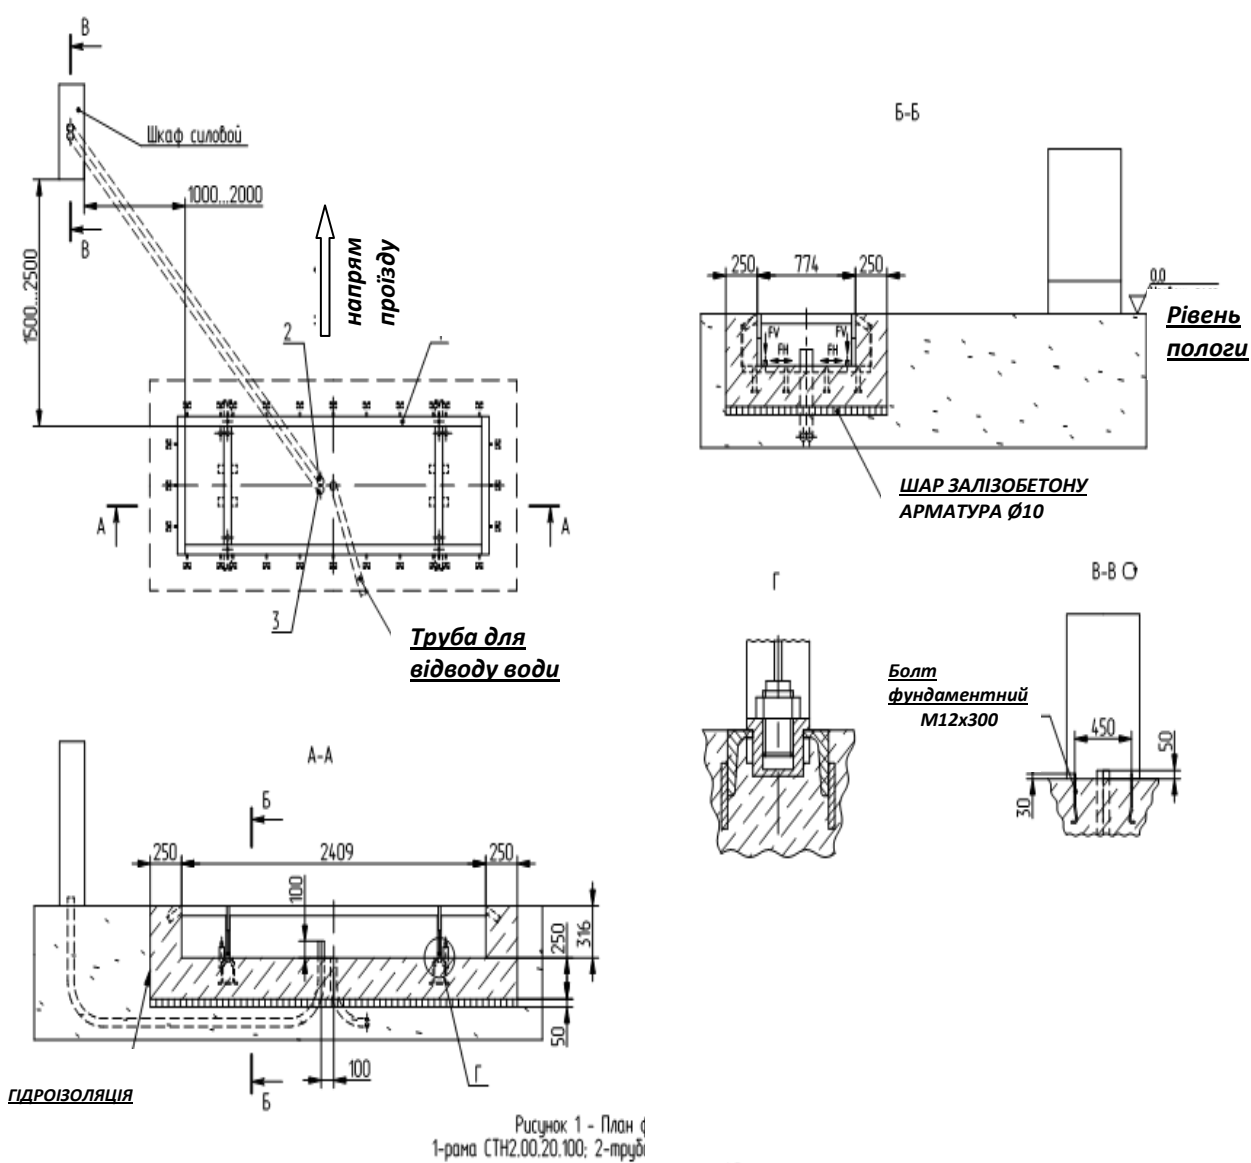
План фундаменту: 1 – рама СТН2.00.20.100; 2, 3 – труба DNSO
